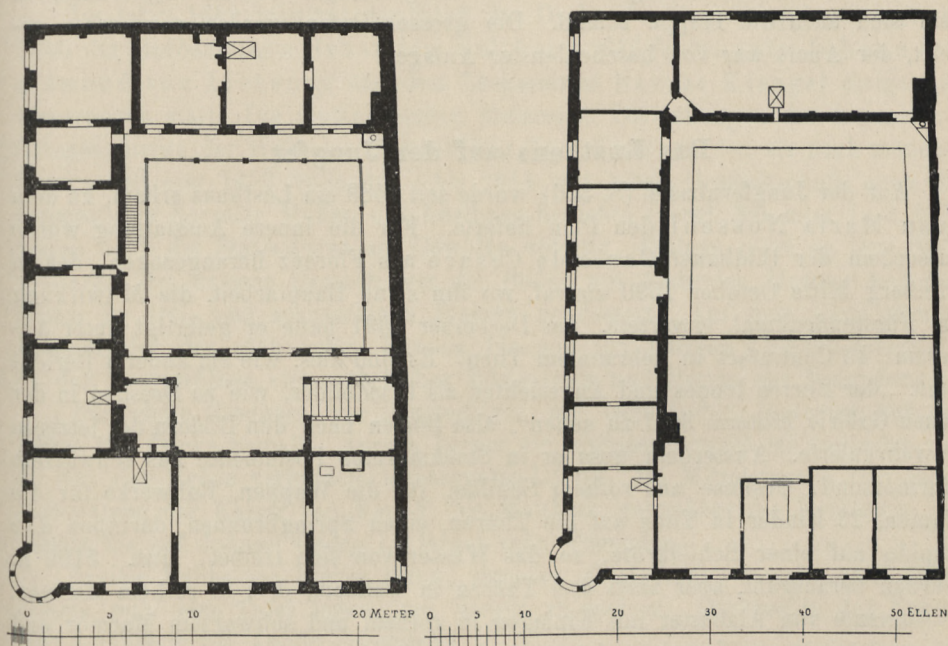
Fraumutterhaus, Grundrisse des 1. und 2. Obergeschosses.
